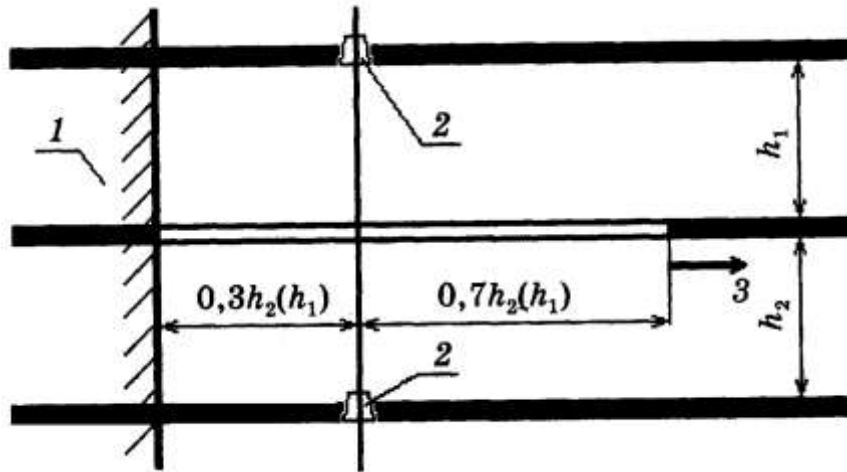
Схема заложения разрезной печи на защищаемом пласте:
